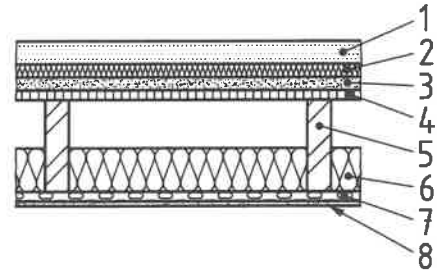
Deckenkonstruktion der Wohnungstrenndecke
